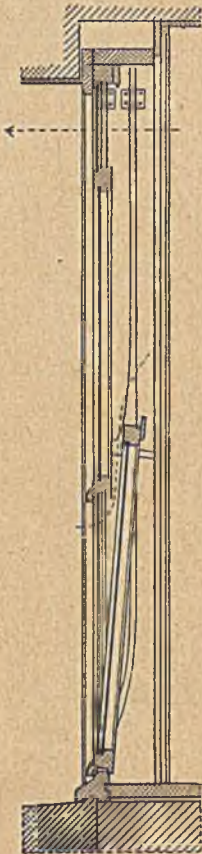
Reform-Schiebefenster z. Lüftung geöffnet.
